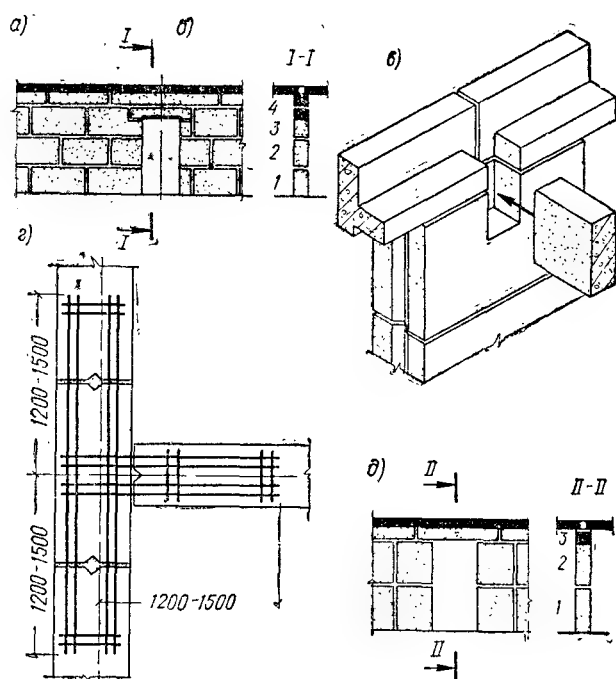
Разрезка крупноблочных внутренних стен а — четырехрядная с вставкой перемычки в вырез стенового блока; б — то же, с добрым блоком; в — гнездо в наружной стене для укладки прогона; г — арматура из круглых стержней в горизонтальных швах сопряжения внутренней стены с наружной; д — трехрядная
